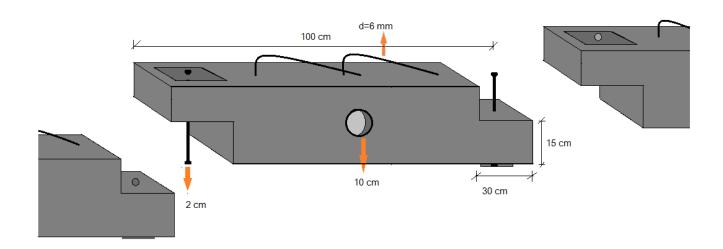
Pieza de fundación prefabricada (diseño experimental)
